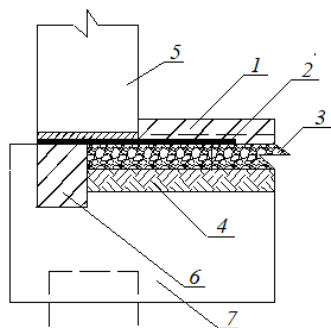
Фрагментированный барьер в виде опирающейся на ростверк и продольную балку плиты пола: 1 — монолитный, армированный дорожной сеткой бетон; 2 — полоса рулонного гидроизоляционного материала; 3 — слой щебня, пролитый расплавленным битумом до полного насыщения; 4 — уплотнённый грунт; 5 — наружная цокольная панель; 6 — дополнительная продольная балка ростверка; 7 — поперечная балка ростверка
